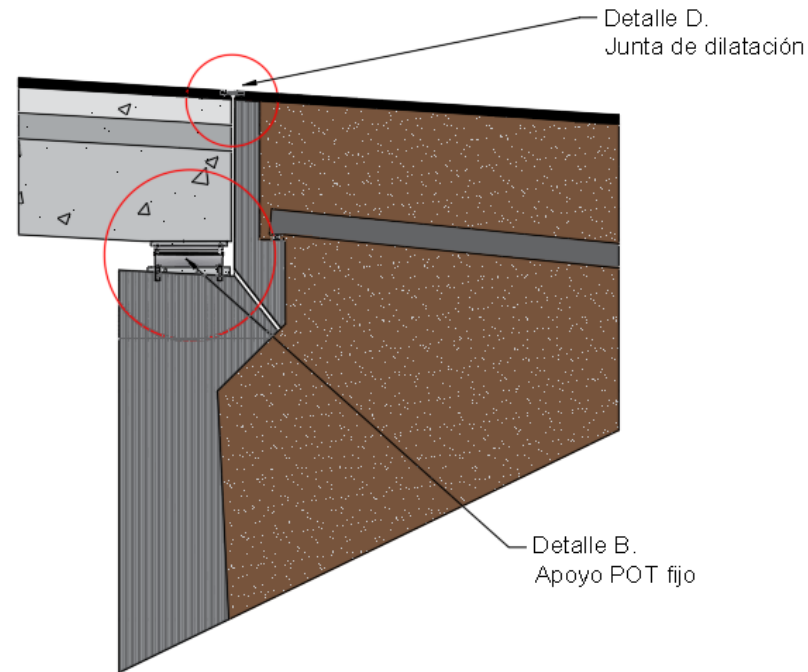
Detalle del apoyo tipo POT y la junta de dilatación en el estribo derecho.
